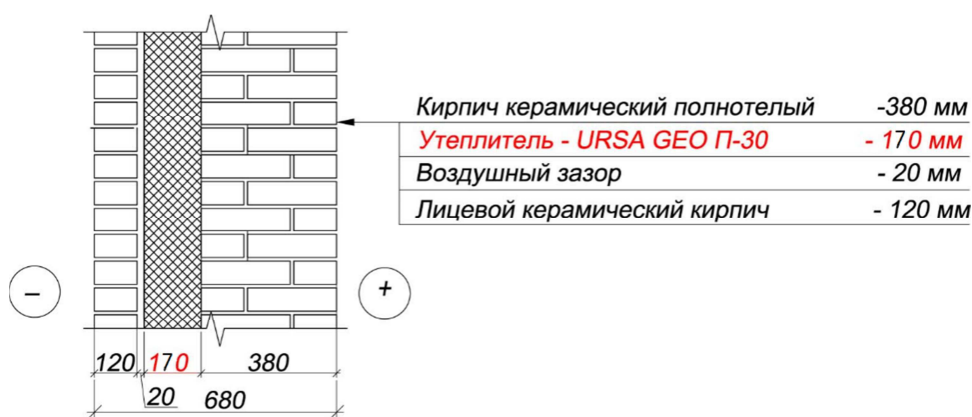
Расчетная схема наружной стены с несущим слоем из кирпичной кладки толщиной 380 мм.
